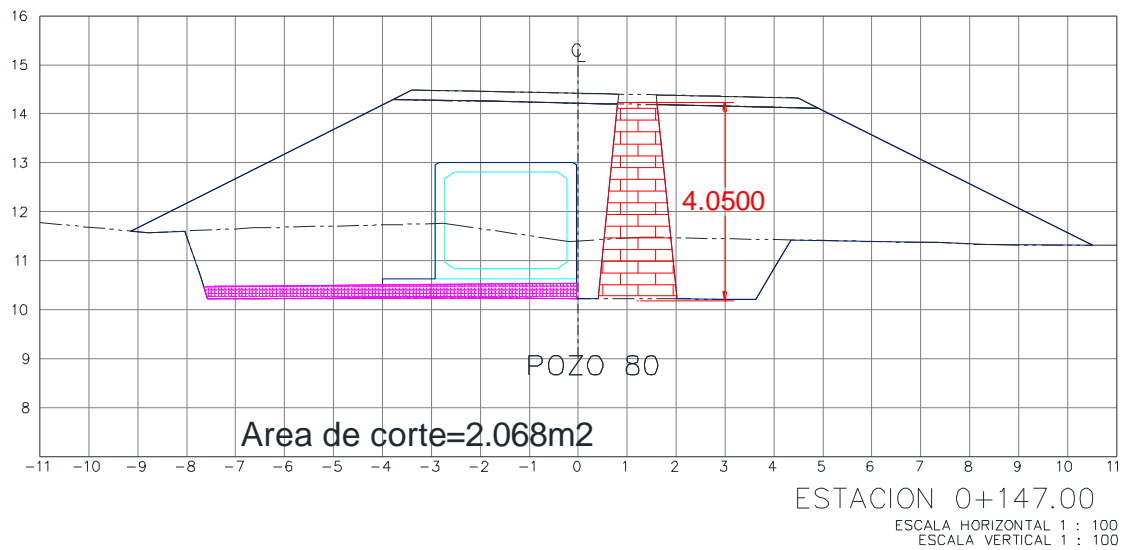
Sección de área de corte en cadenamiento 0+147.00
